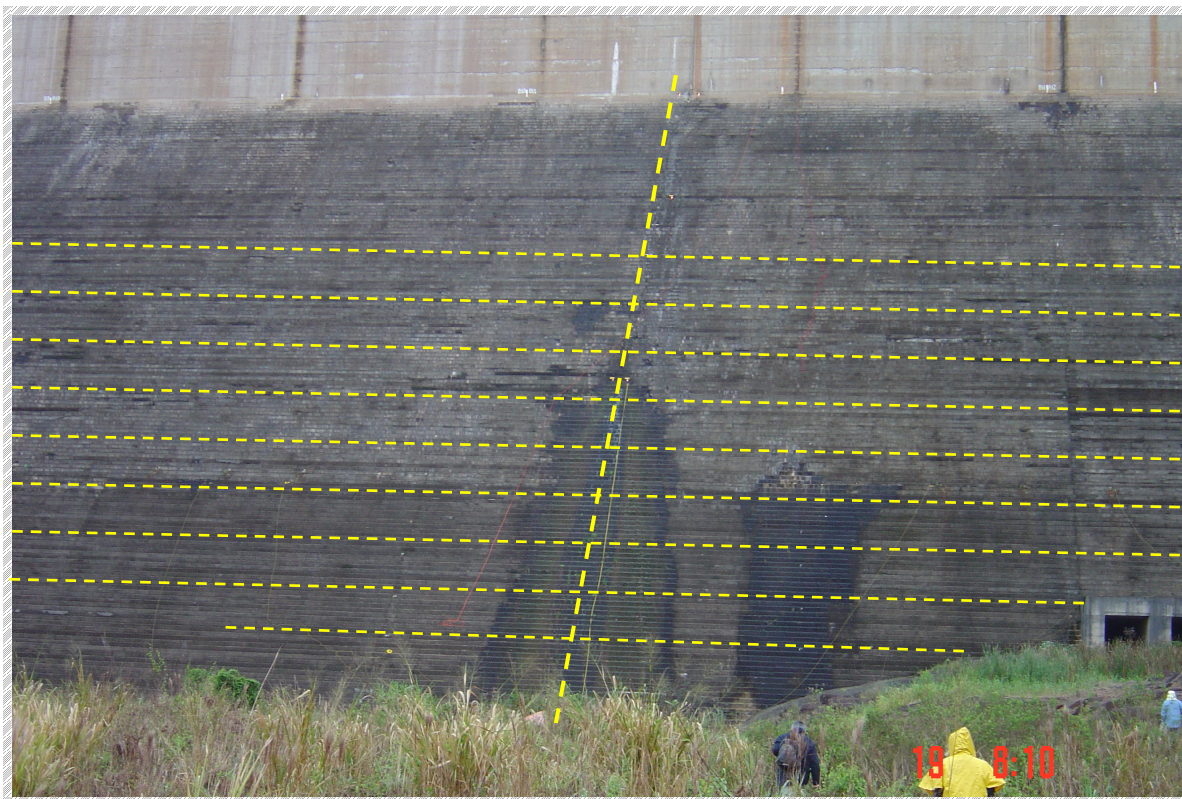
Vista jusante das fissuras do bloco B11. As linhas tracejadas horizontais representam as projeções das linhas de ensaio de SP nesta etapa. No canto inferior direito pode-se observar a “adufinha” e o contato entre o concreto da barragem e o maciço rochoso.
